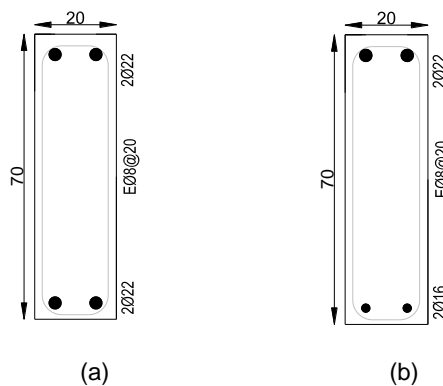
Disposición de la armadura. (a) Corte de viga V1. (b) Corte viga V2.
